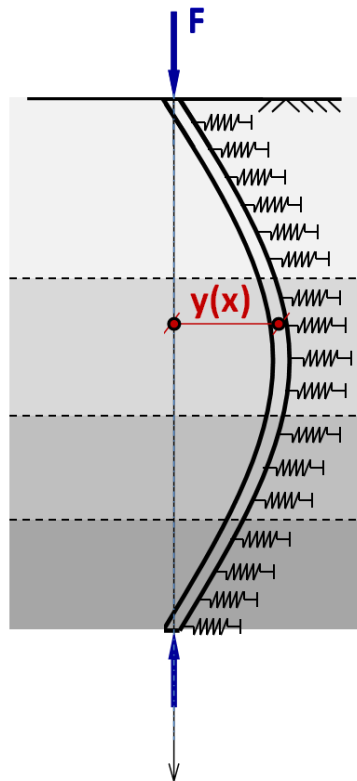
Instabilité élastique par flambement d'une fondation profonde
